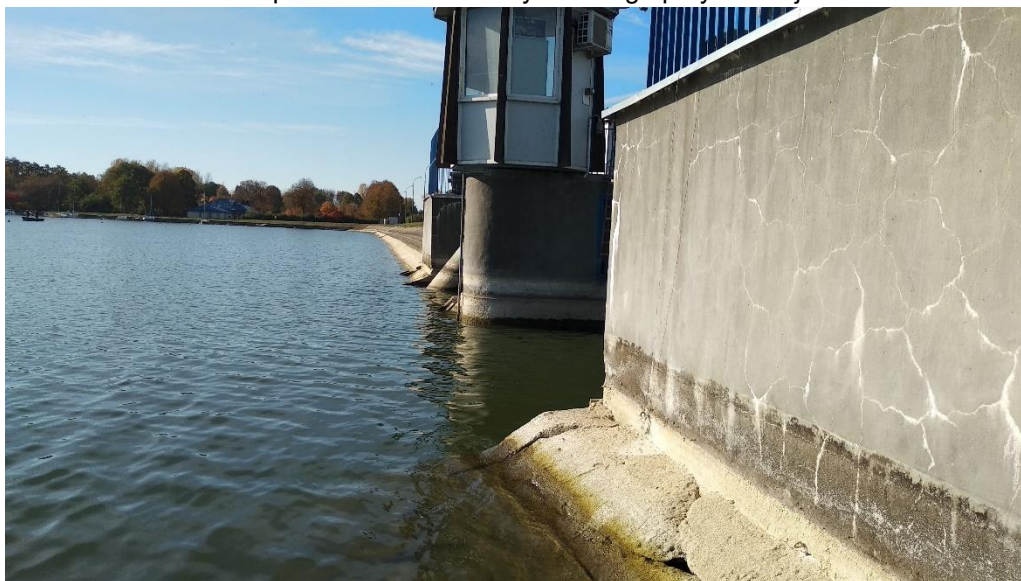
Widok powierzchni betonowych lewego przyczółka jazu od WG.
